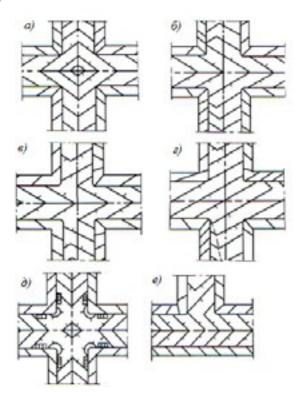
Схема вертикальной планировки перекрестков: 1 — на холме; 2 — на водоразделе; 3 — в тальвеге; 4 — на косогоре; 5 — в котловине; 6 — Т-образный перекресток
